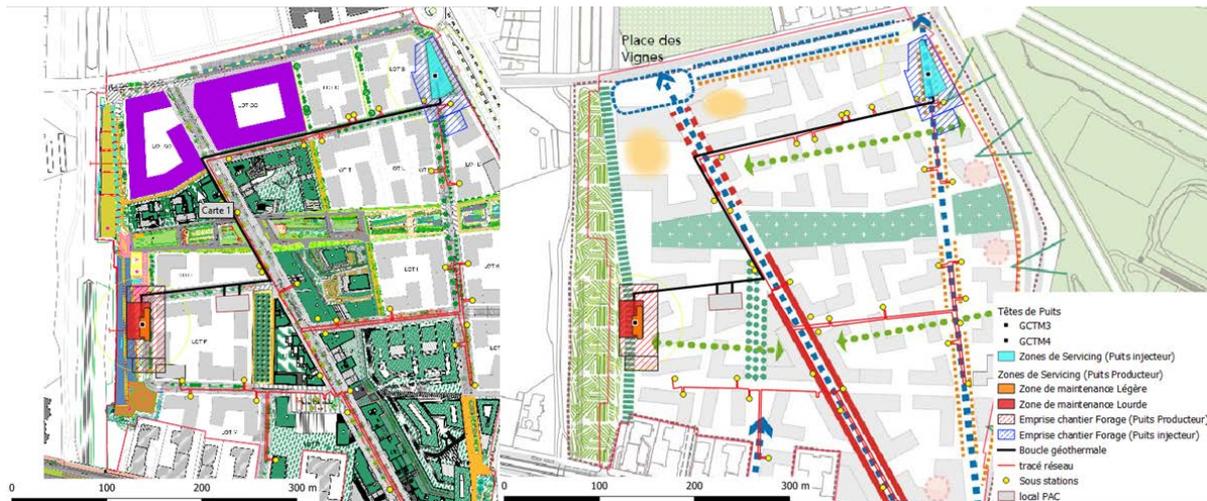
Plan de masse de la ZAC après aménagement (A), OAP de la ZAC dans le PLU (B)
